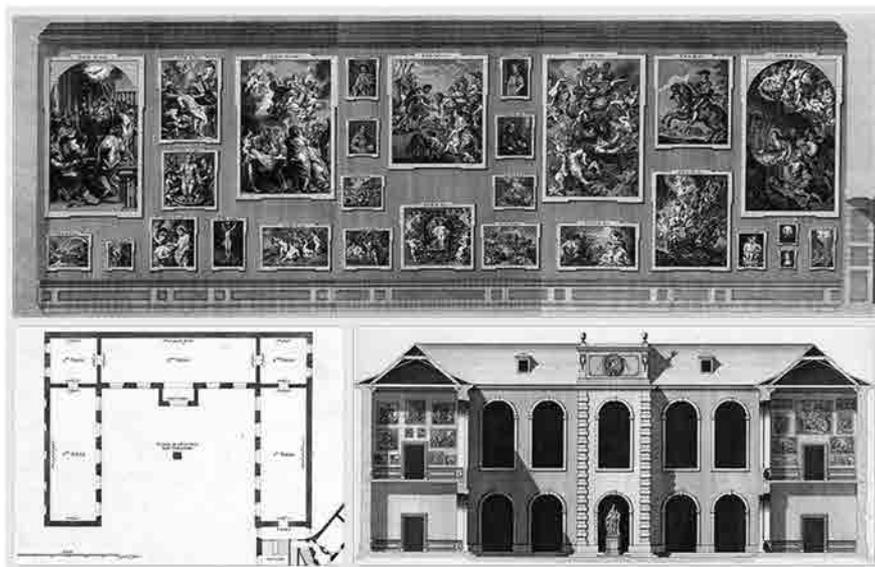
| *Galleria Elettorale*, Düsseldorf: sezione, pianta e prospetto interno della seconda sala (dipinti di P. Strudel, A. Van Dyck, B. Flemael, H. van Acken, G. de Lairese, D. Vinckboons, A. Schoonjans), da De Pigage, von Mechel, *Galerie Électorale*, 1778.
